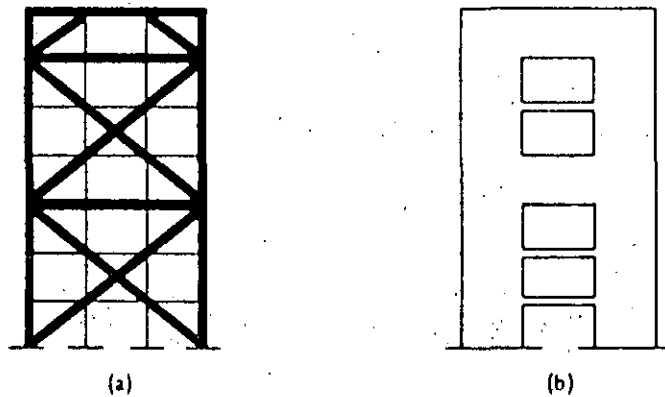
Uso eficiente de elementos rigidizantes. a) Contraventeo en cruz, b) muros de cortante y vigas de acoplamiento.
